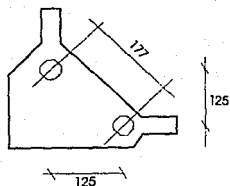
VISTA EN PLANTA DEL DADO D-4
